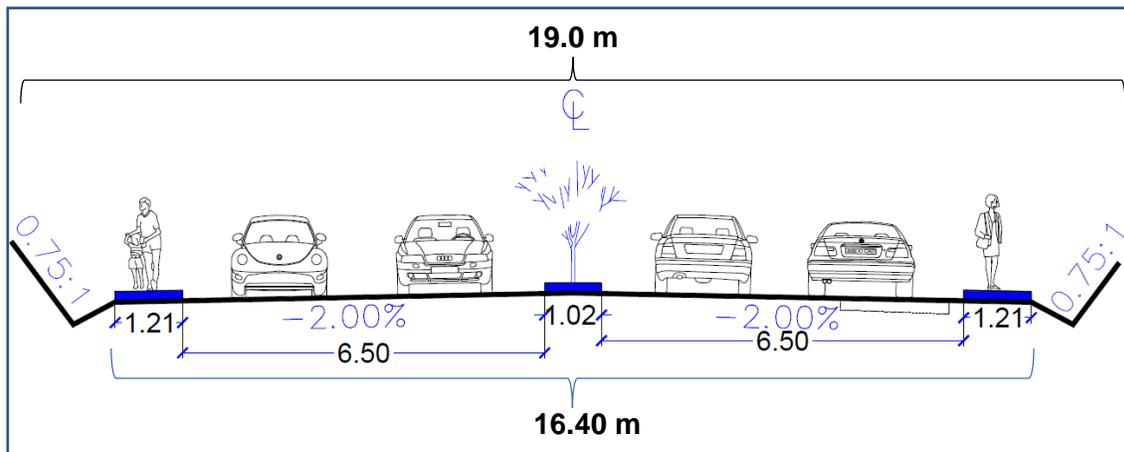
Sección tipo del Proyecto de construcción del Boulevard San Luis Rey de Francia
